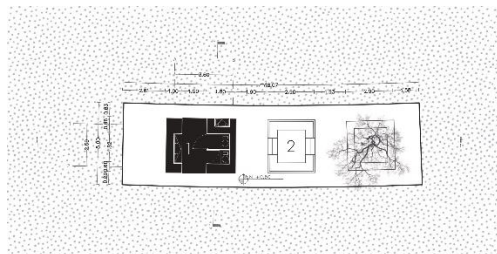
Planta Pabellón de apoyo tipo I.
